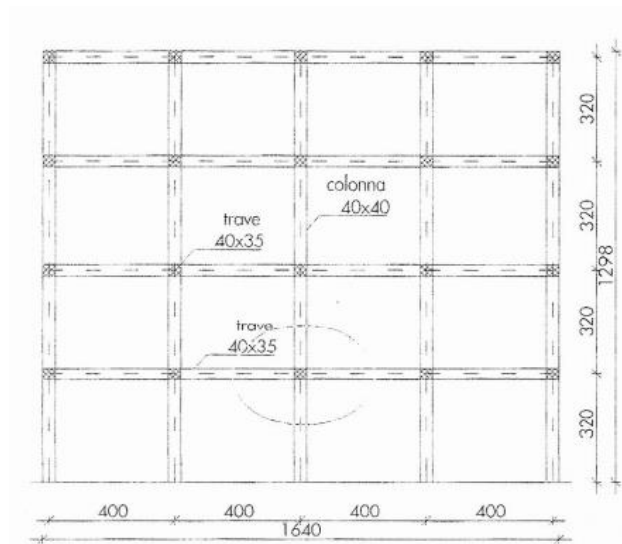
Prospetto del telaio con indicazione del nodo trave-pilastro estrapolato
